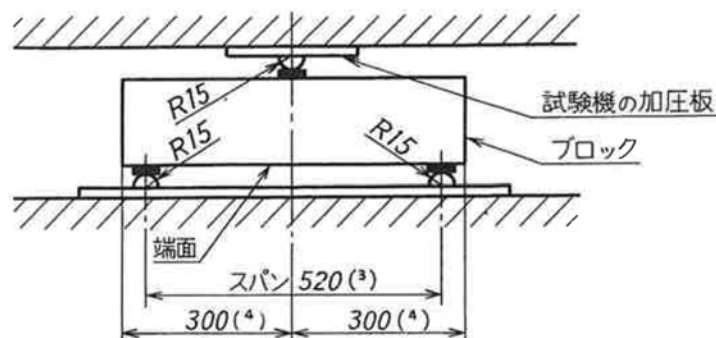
曲げ強度試験の概要 (JIS A 5371 より抜粋)
